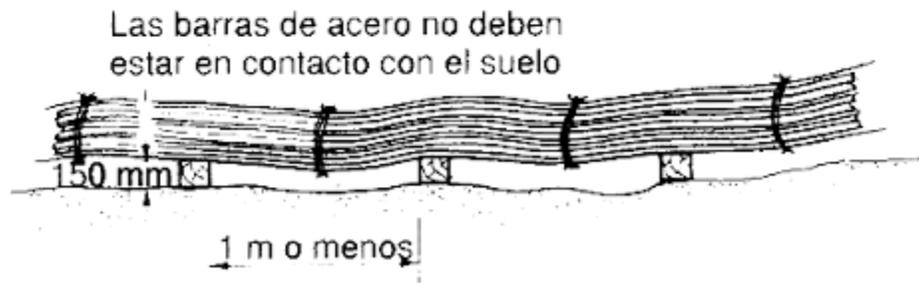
Ejemplo de protección para los materiales de construcción en la obra.
